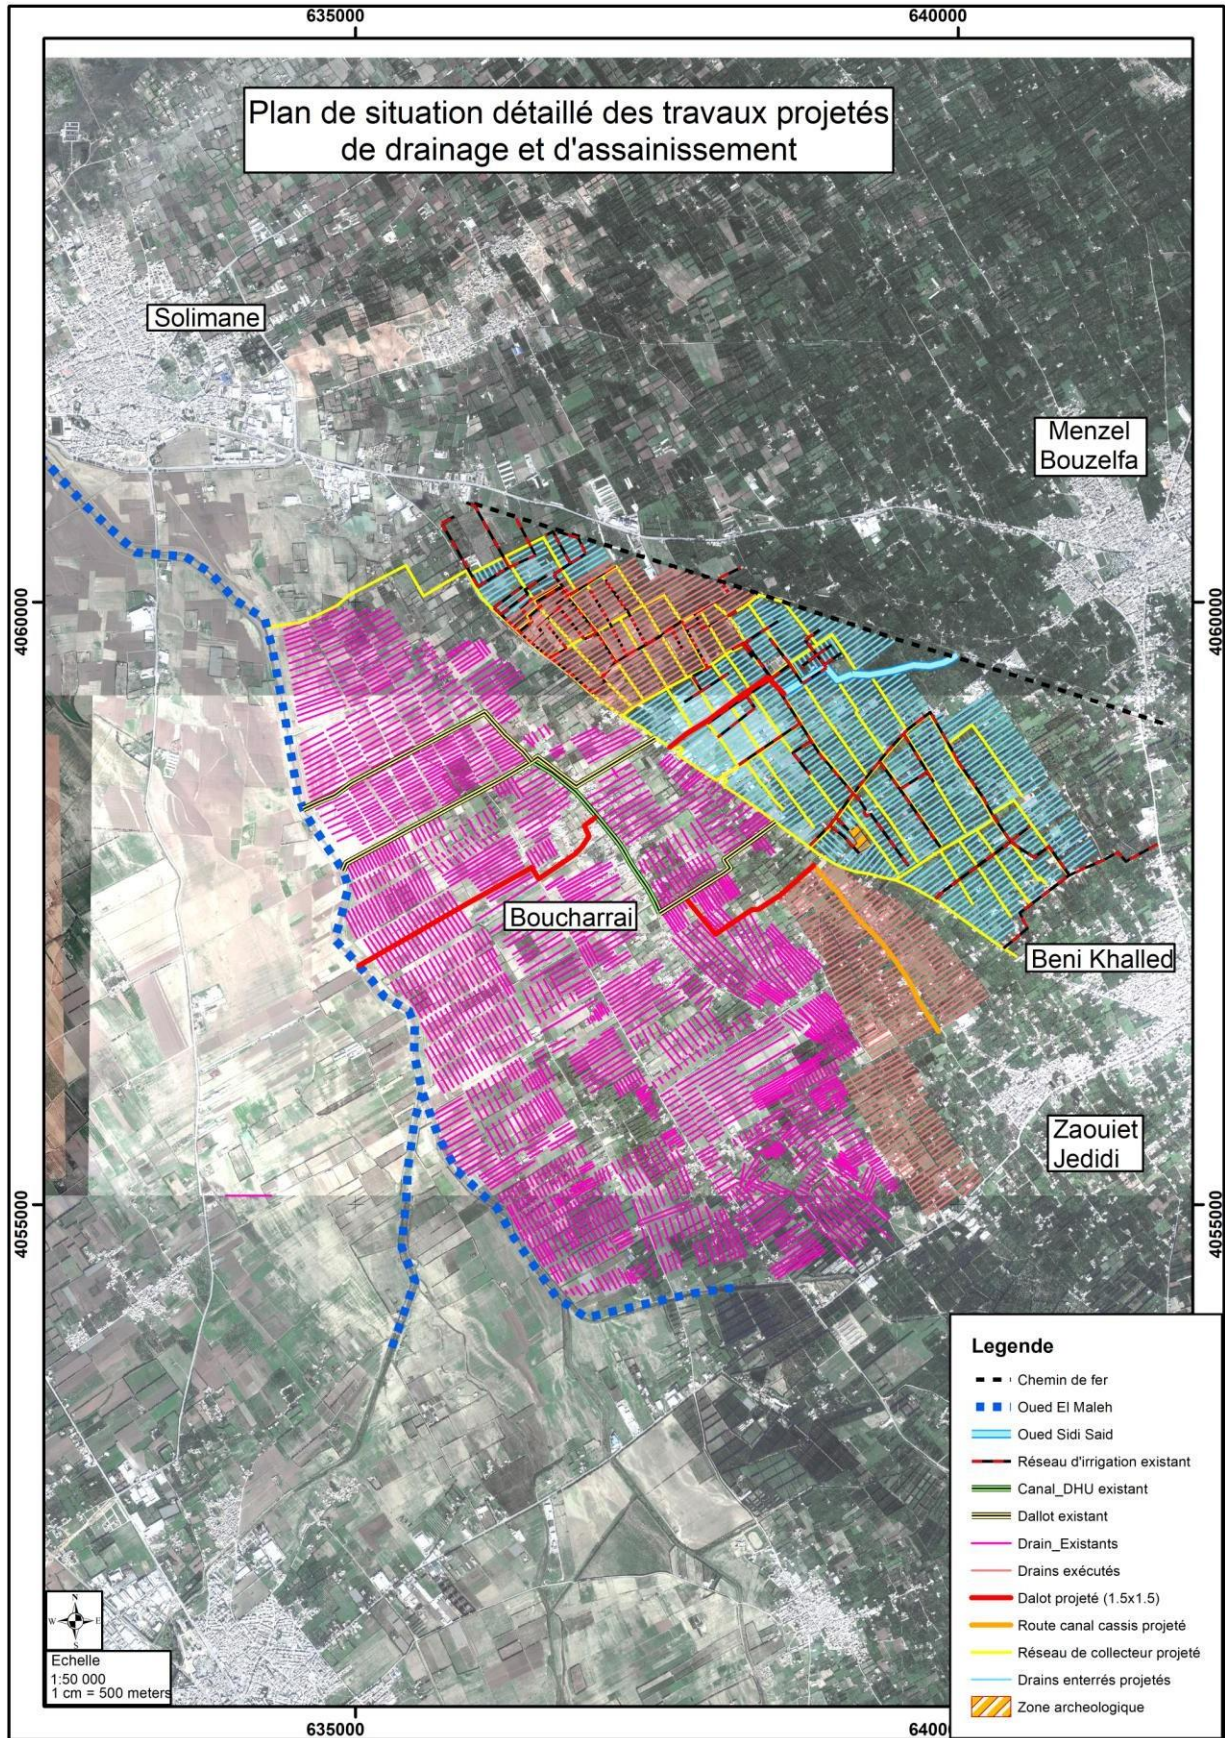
Plan de situation des travaux d'assainissement et de drainage
